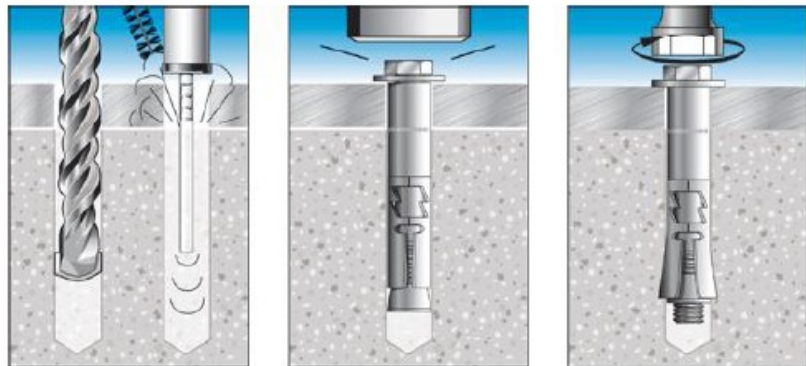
26 Konstruksi Baut Tanam Pada Furnitur
